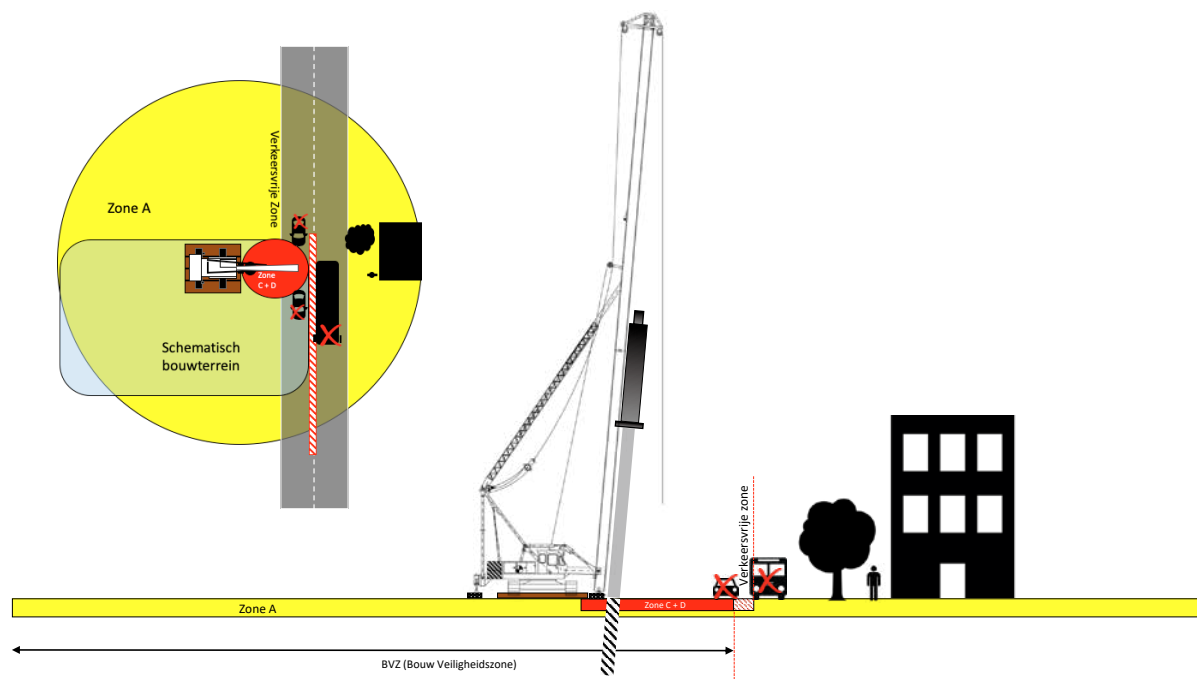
Overzichtstekening te lood funderen met PD-stelling/giekstelling & GLS-stelling/vouwstelling/sheetpilar – type GLS (hoofdgroep B en C)
